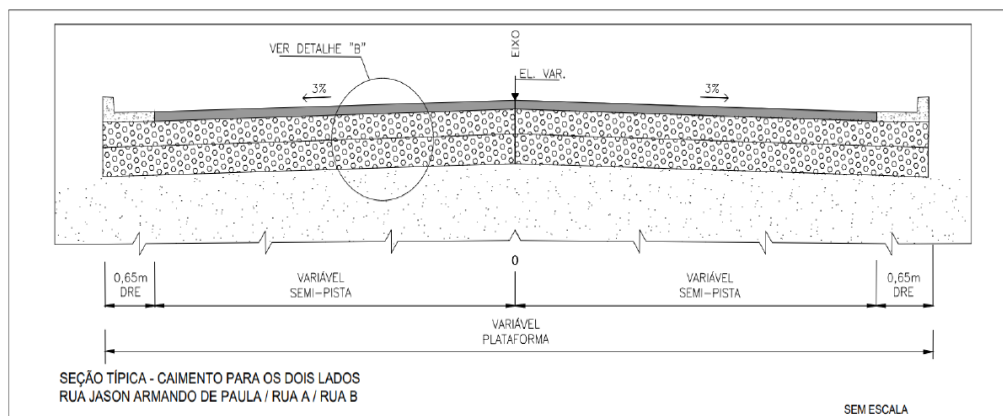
Seção Típica Rua Jason Armando de Paula / Rua A / Rua B
